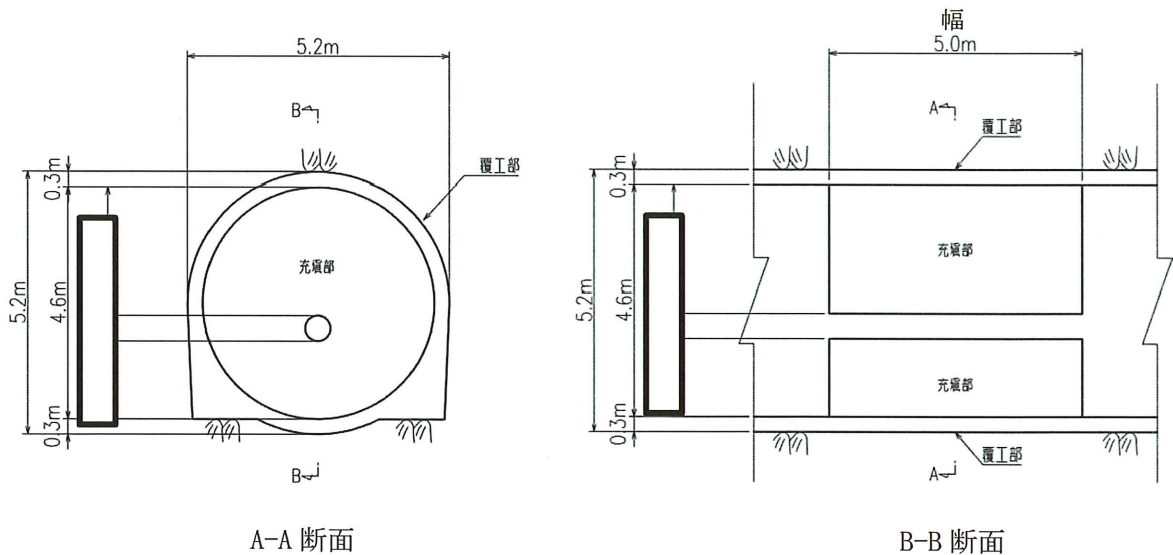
(2) 取放水路流路縮小工（第1号機放水路） 断面図
